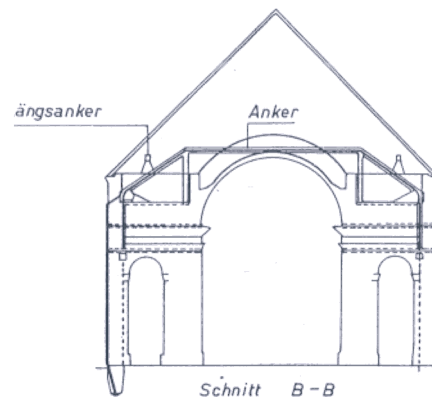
La cathédrale de Saint-Gall. Coupe donnant le schéma de la consolidation statique, avec l'indication des câbles tendeurs traversant les piliers et des câbles transversaux, ancrés dans les fondations, qui absorbent la poussée horizontale.
